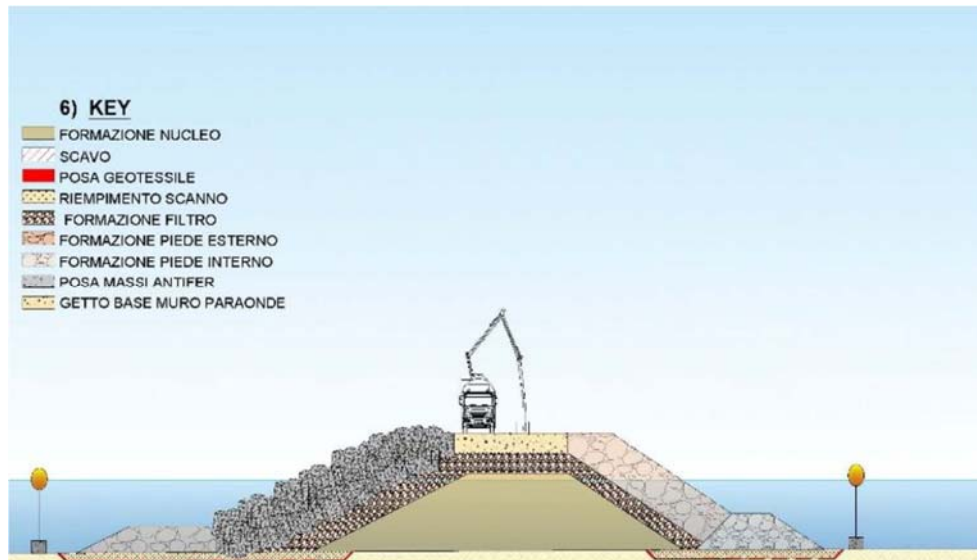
Fase 6: realizzazione fondazione muro paraonde
